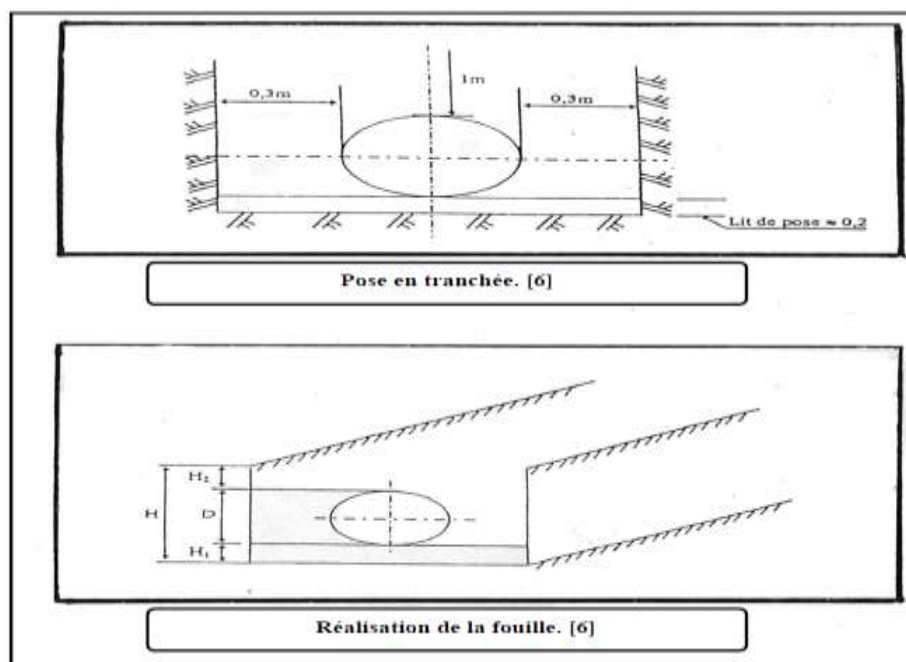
Schéma d'une tranchée avec une conduite circulaire.
